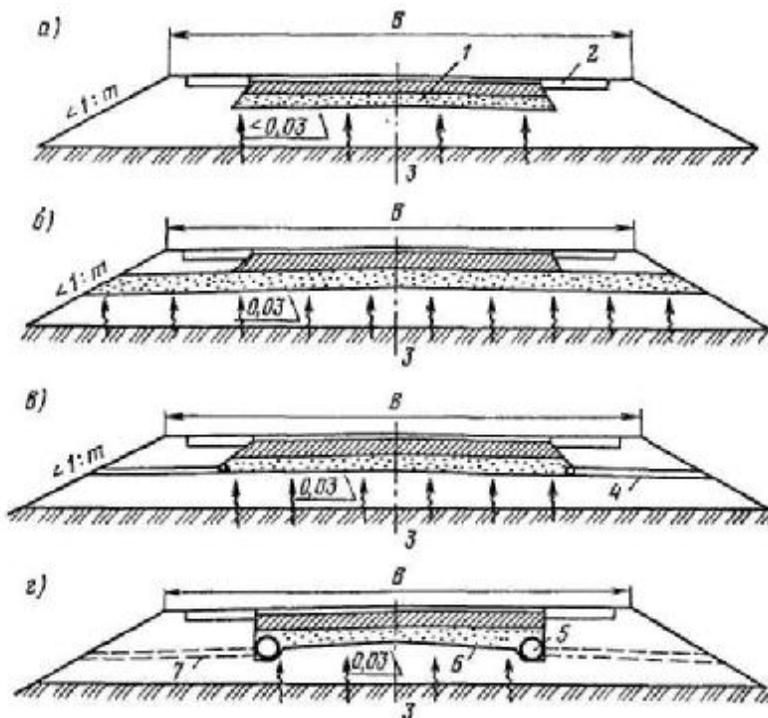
Типовые конструкции оснований дорожных одежд
